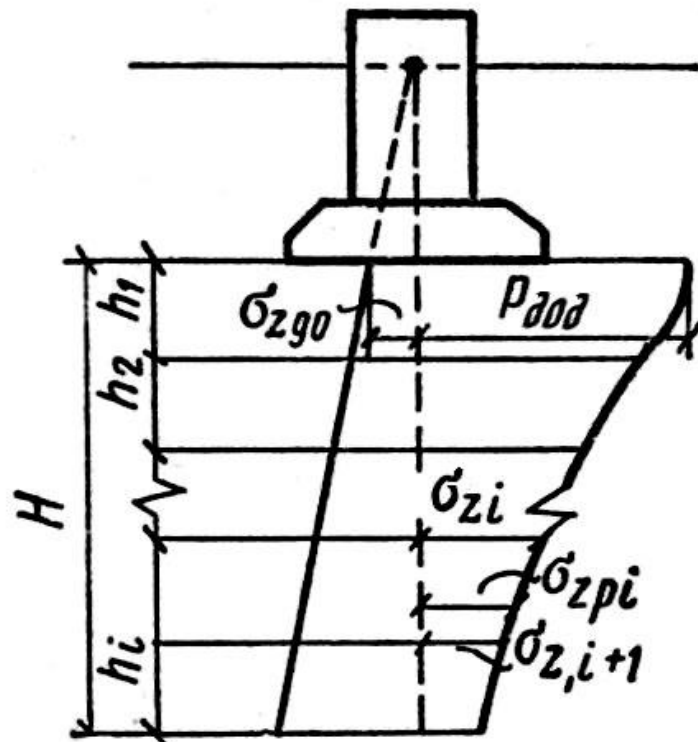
Схема до розрахунку осідання методом пошарового підсумовування
